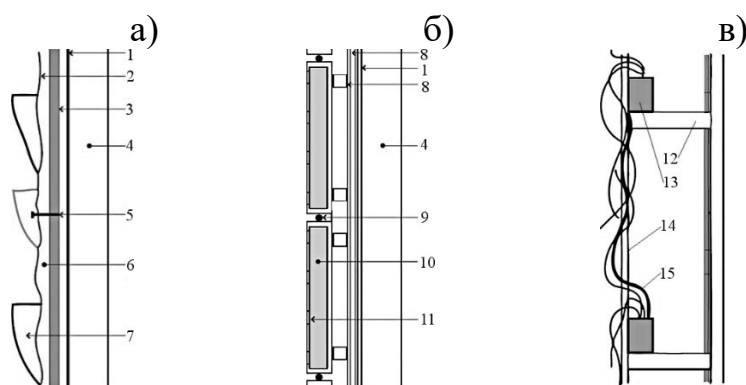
Конструкція фасадного озеленення за принципом будови: а – повстяна; б – модульна; в – контейнерна з ампельними рослинами: 1 – гідроізоляція; 2 – шар повсті; 3 – бак з водою; 4 – основа; 5 – кріплення; 6 – водопровідний шар; 7
